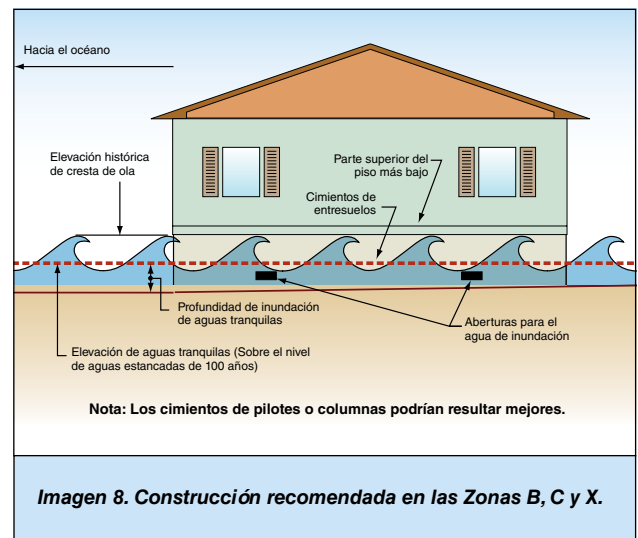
Construcción recomendada en las Zonas B, C y X.
